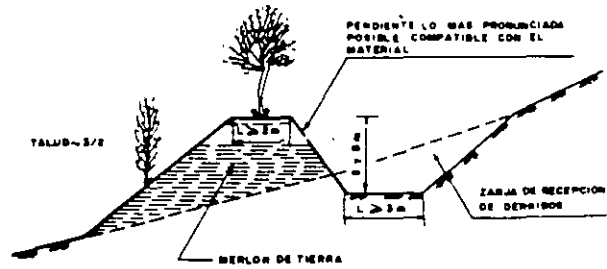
Perfil transversal típico de un merlón de tierra y zanja de recepción de derrubios.
